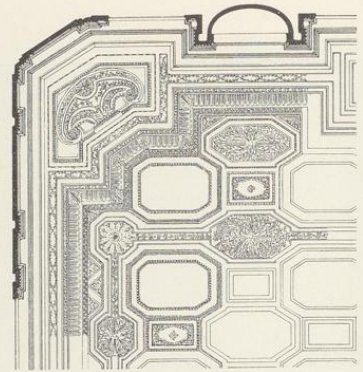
Stuckdecke des Saales im Erdgeschosf
